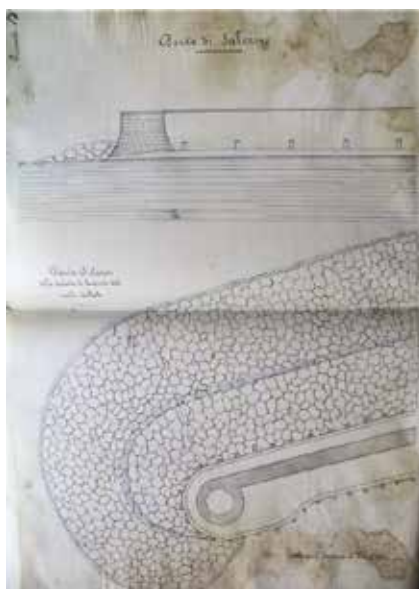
Pianta ed elevato della testata di levante del molo isolato* (ASSa, Genio Civile, b. 260).
